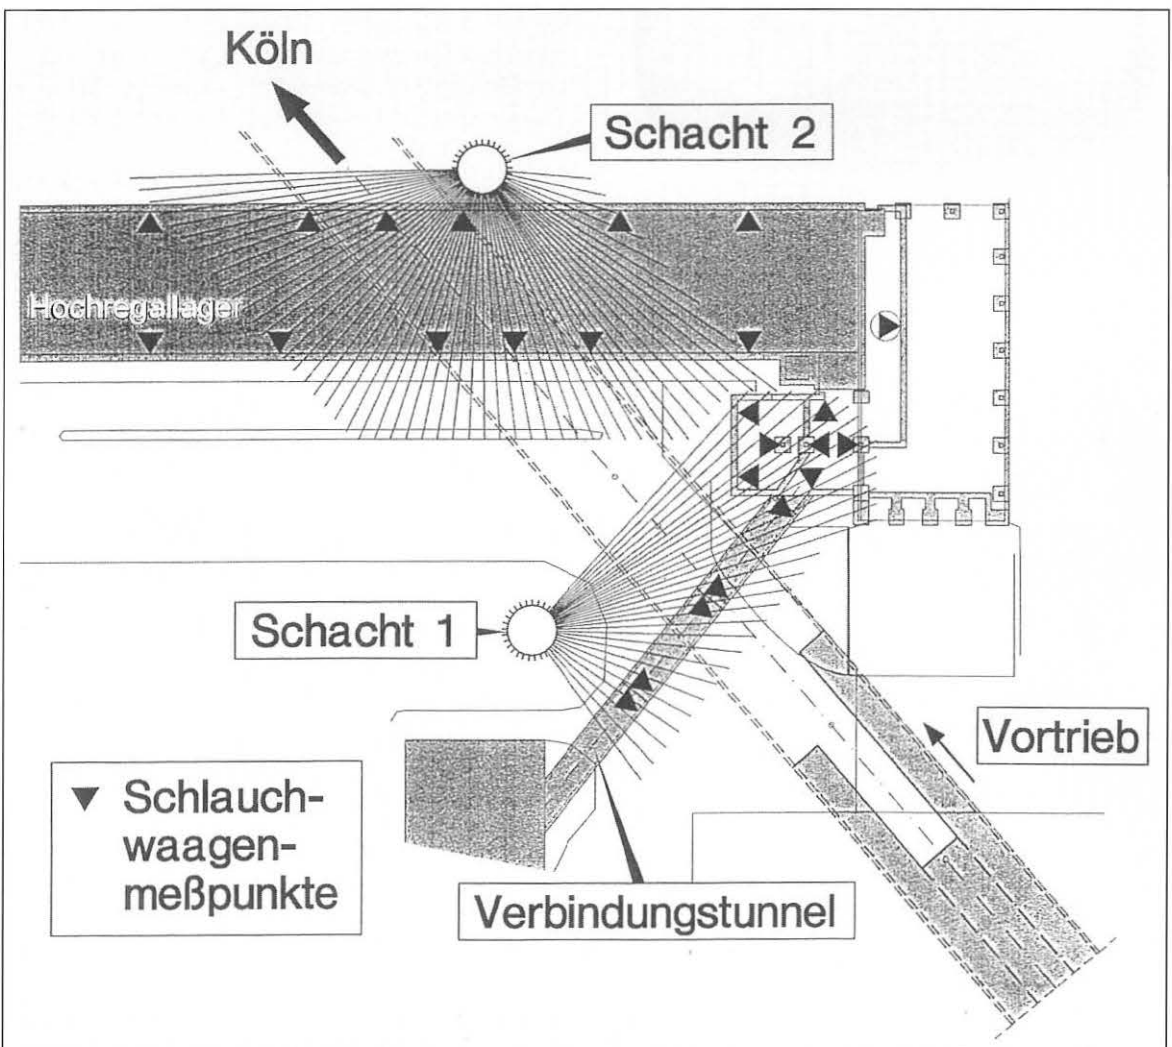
Tunnel Limburg, Unterführung Hochlager, Lageplan
